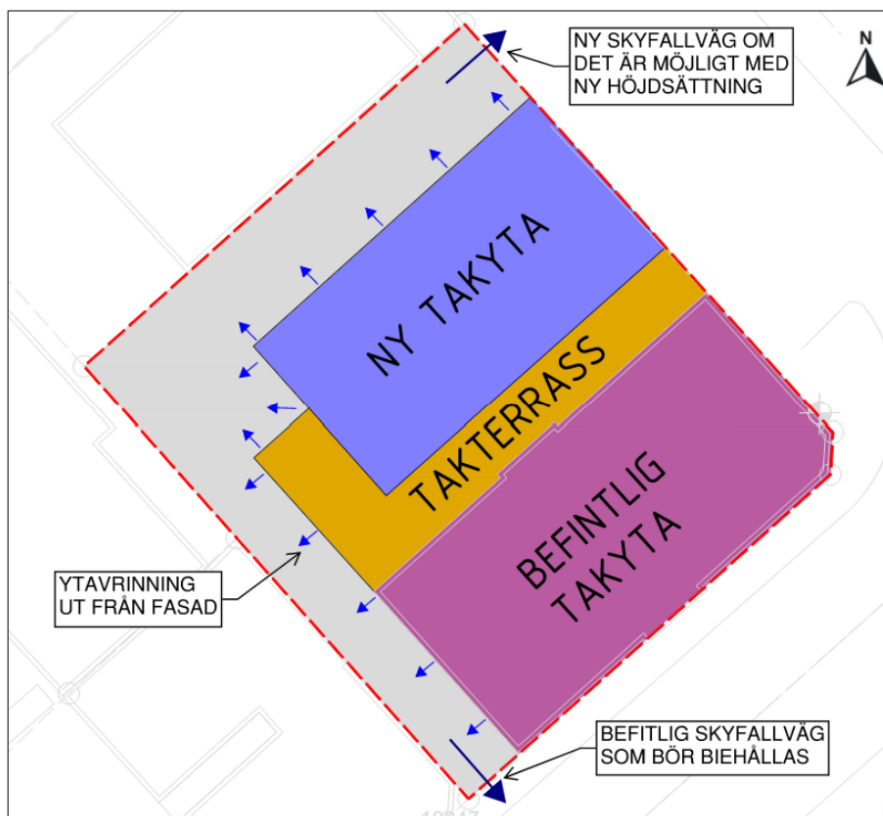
Skyfallsplan ny planerad situation. Om möjligt bör höjdsättningen av gårdsytan i och med den planerade exploateringen utformas för att leda skyfallsvatten enligt flödespilar (Structor Uppsala AB, 2021-06-24).
